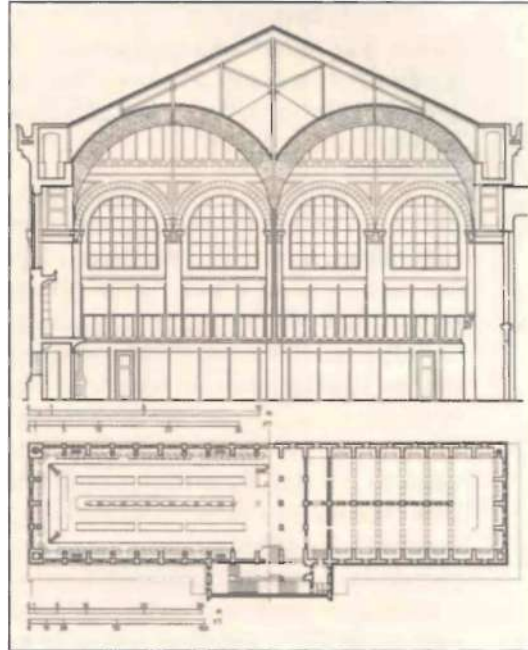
Planta y sección de la Biblioteca de Sainte-Geneviève de Henri Labrouse (París, 1843).
